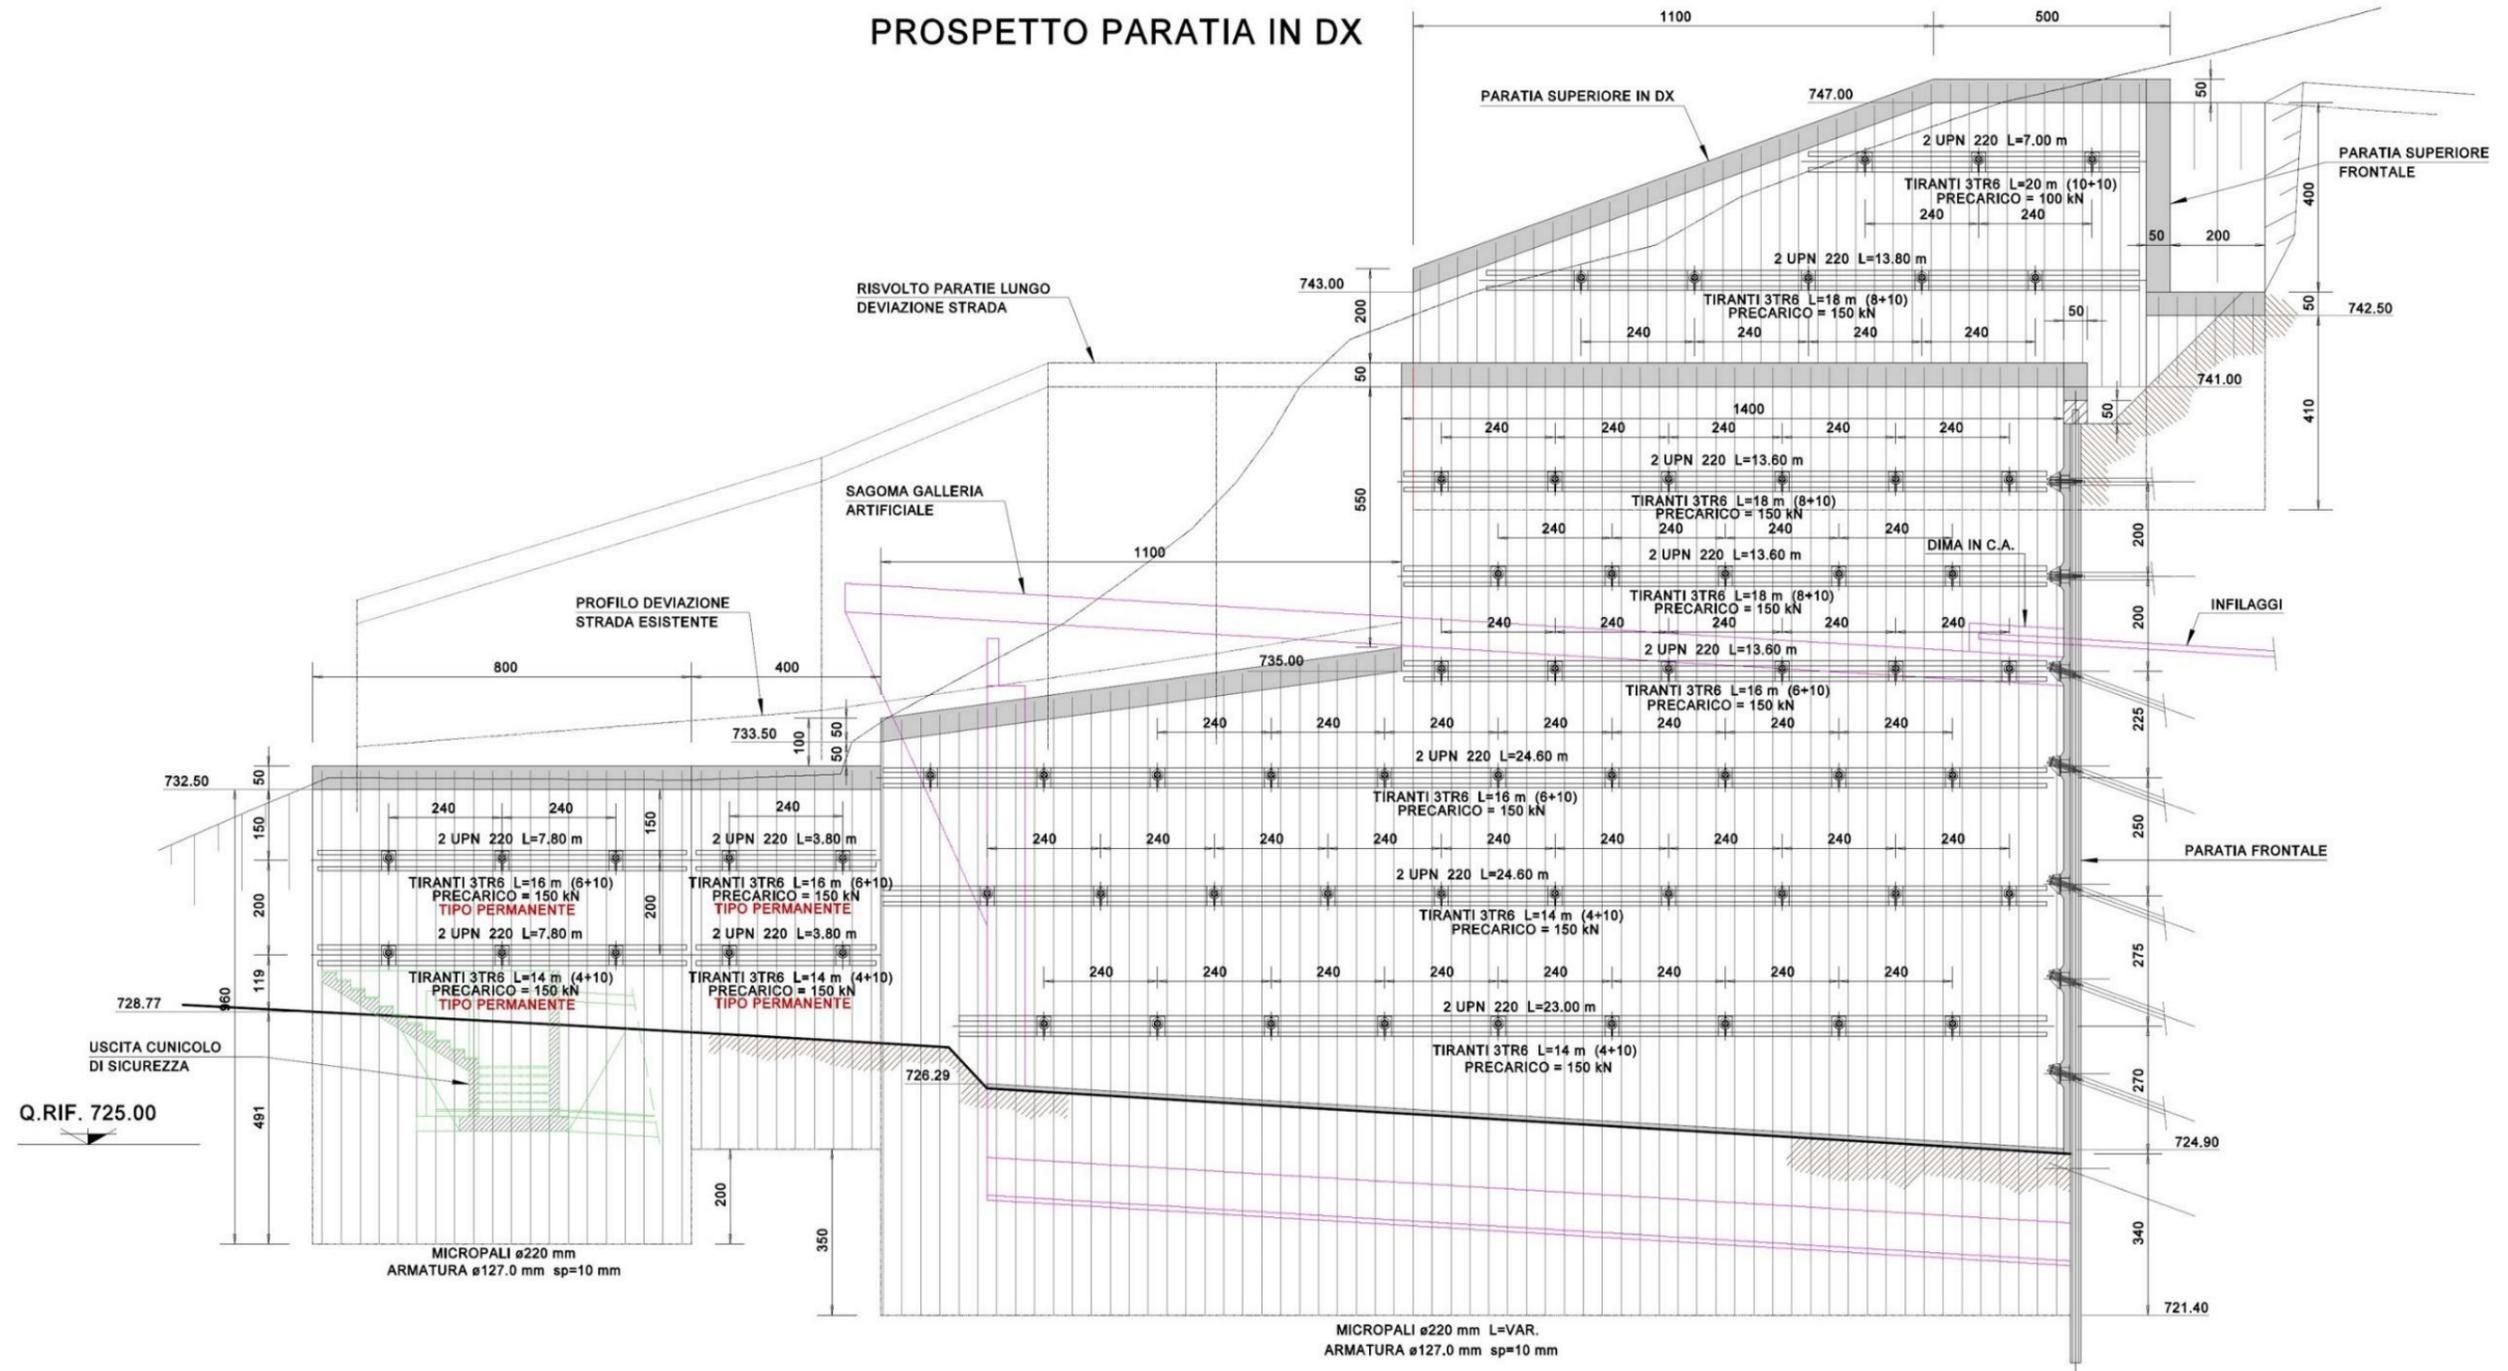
Galleria naturale Imbocco – Paratie berlinesi – Prospetto paratia in destra
